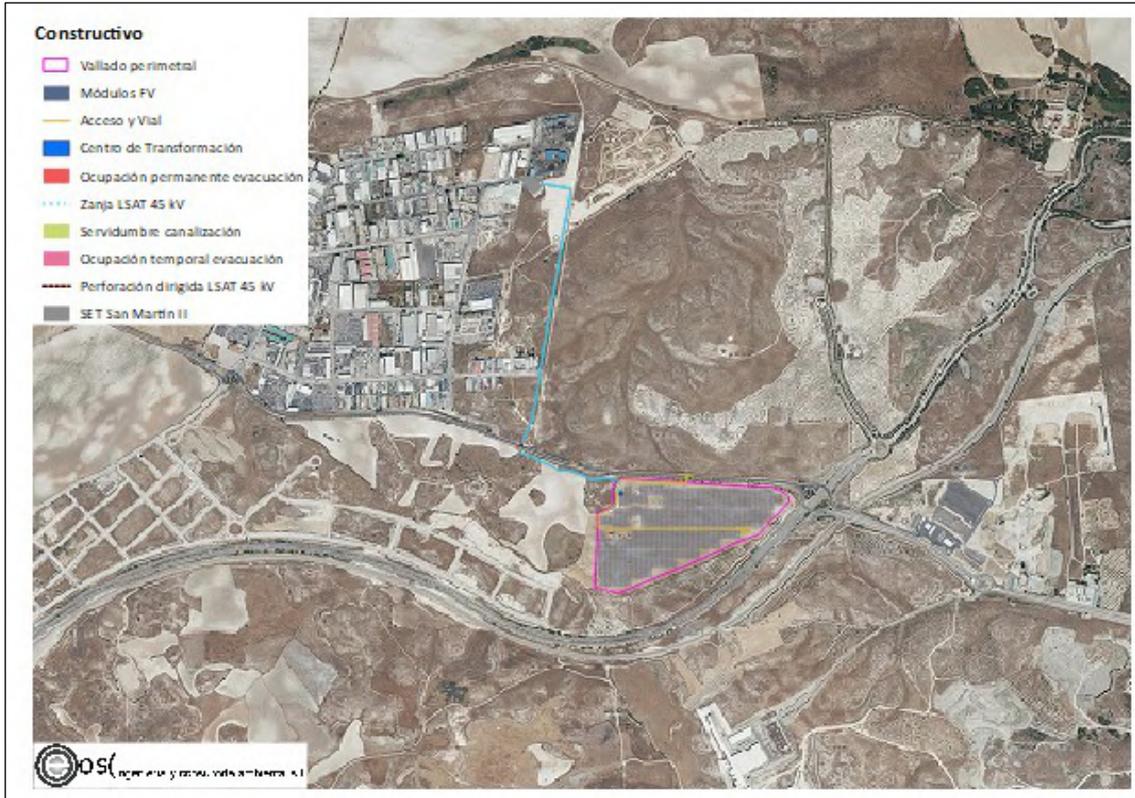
Planta Fotovoltaica en proyecto sobre el MDT. Se muestra el constructivo y la orografía del entorno.
